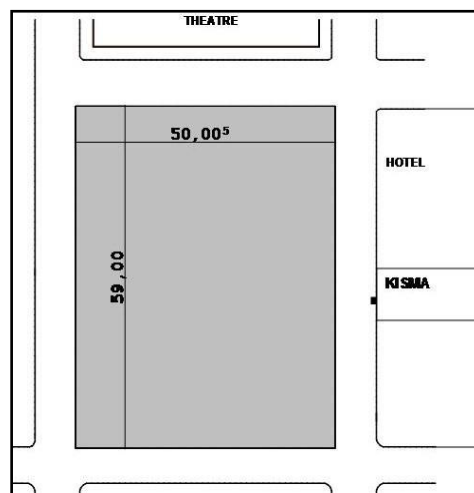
Rapport entre la longueur et la largeur du plan, de la place du théâtre, Source : Auteur 2011.
